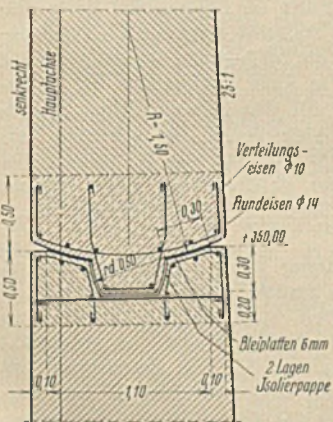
Gelenk im Betonkern des Staudammes am Ausgleichbecken Burgkammer der Bleilochsperre.
